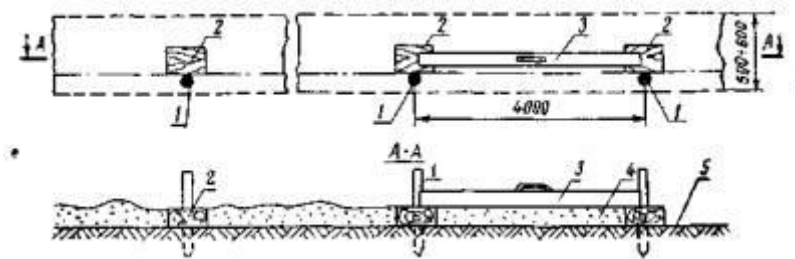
Підготовка основи для встановлення рейок - форм:
